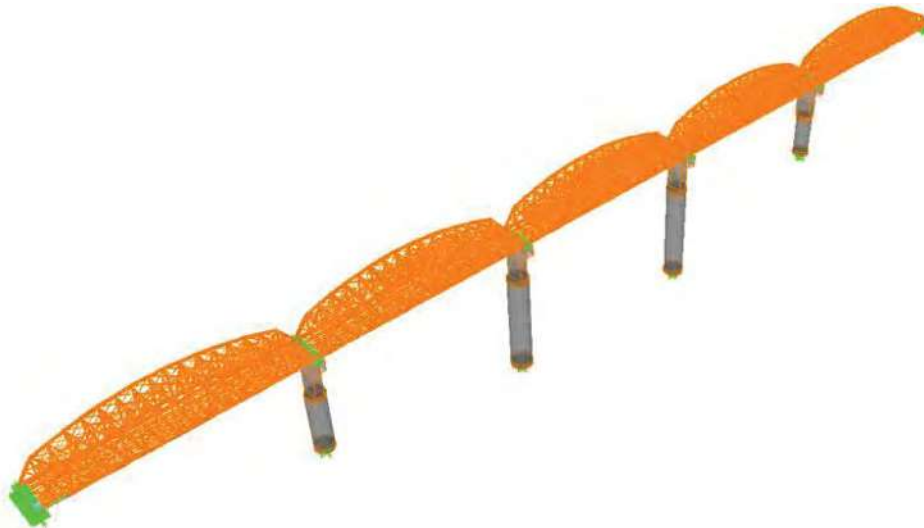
Modelo del puente con elementos barra (Aguilar y Jara, 2006).
